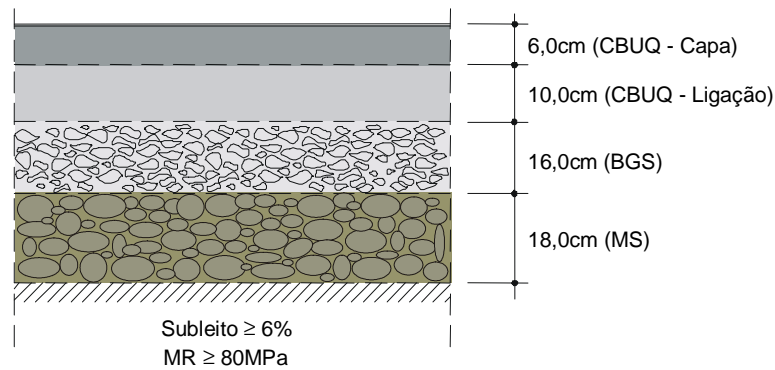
Estrutura de pavimento – Pista de rolamento
